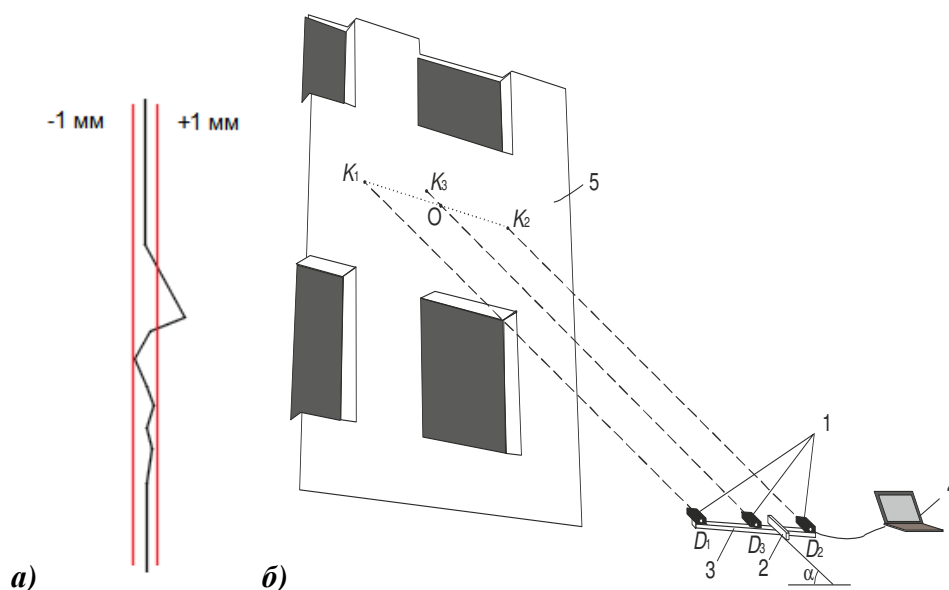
Процесс измерения: а) общий вид измерения «кривая поверхности»; б) прибор для бесконтактного контроля ровности поверхности строительных конструкций
